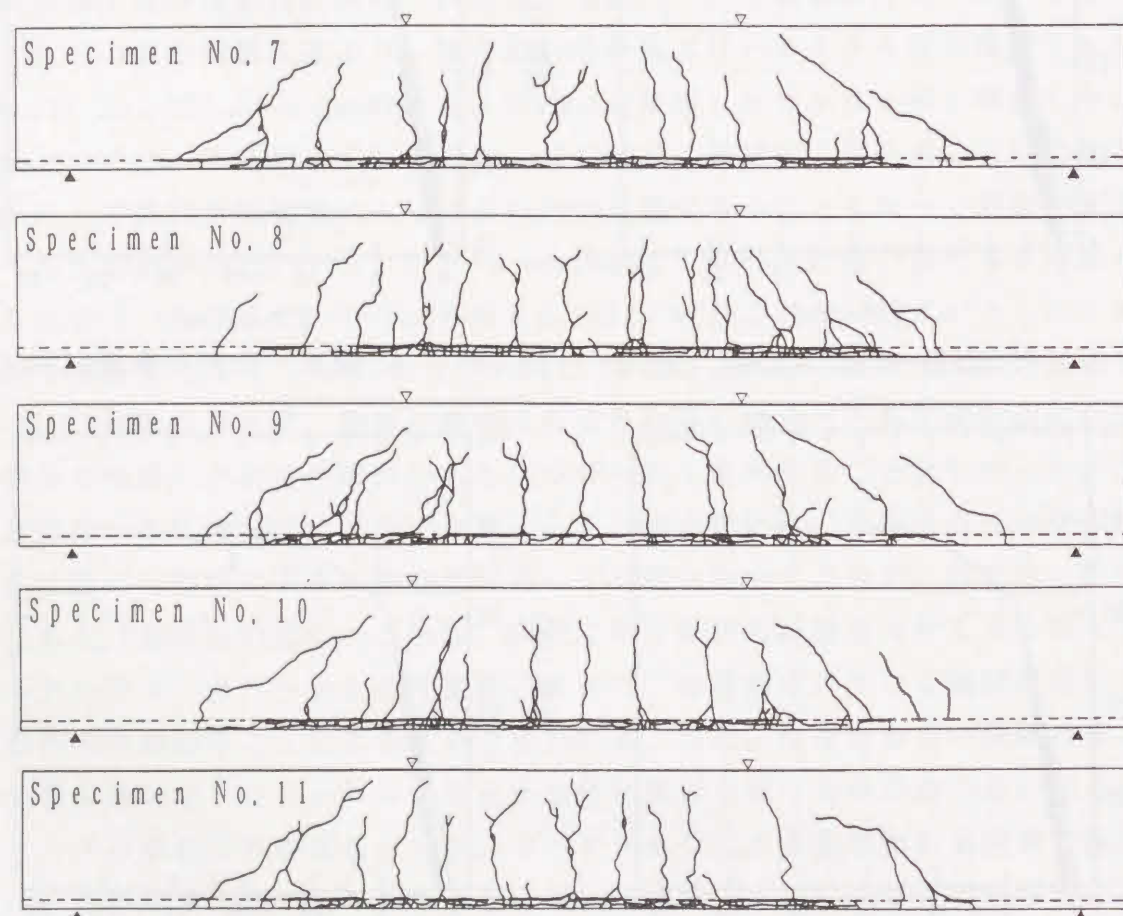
鉄筋コンクリートはりのひびわれ状況(1)
